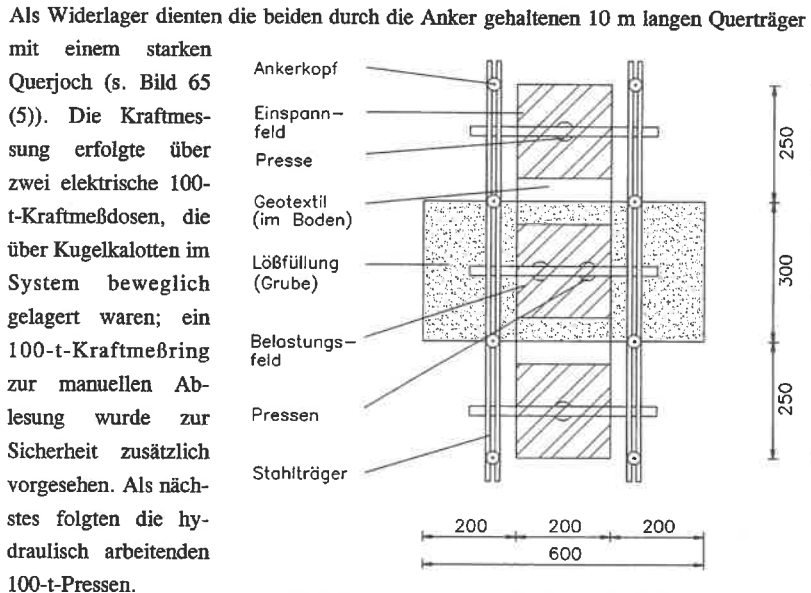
Draufsicht auf das Versuchsfeld (Maße in cm)
